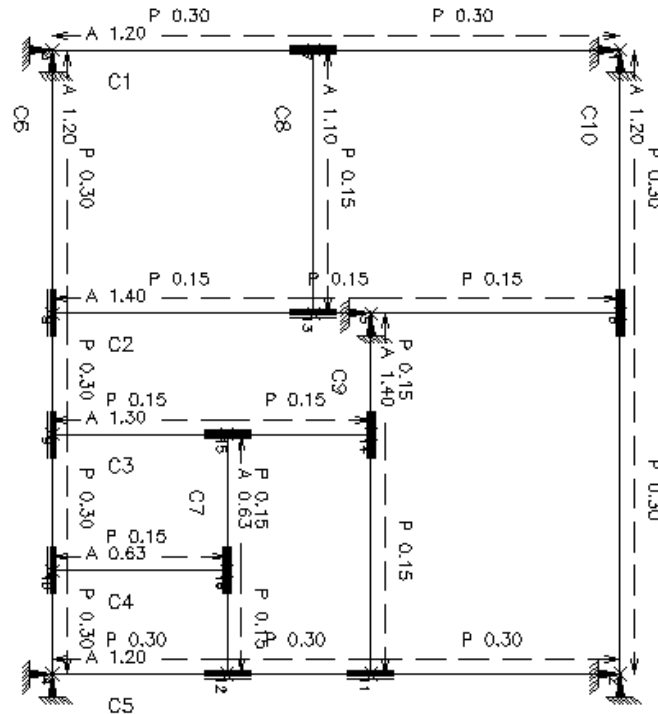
Distribuição das cargas nas vigas de fundação
